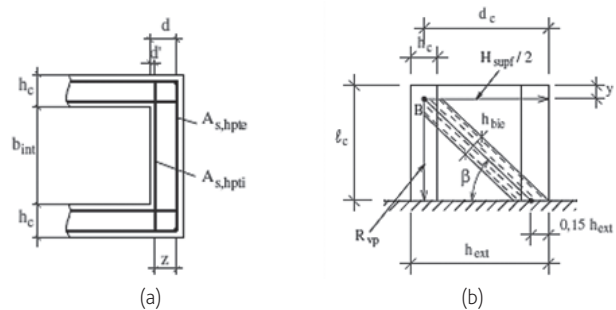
Representação: (a) armaduras transversais; (b) biela e tirante na parede longitudinal [1]
